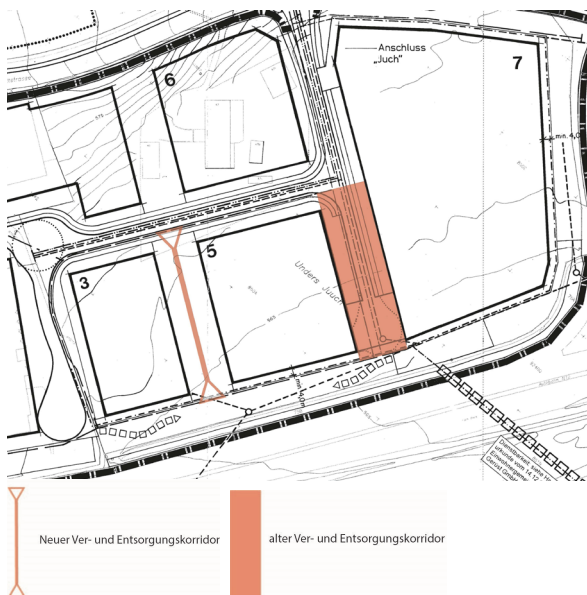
Ausschnitt Ver- und Entsorgungsplan
